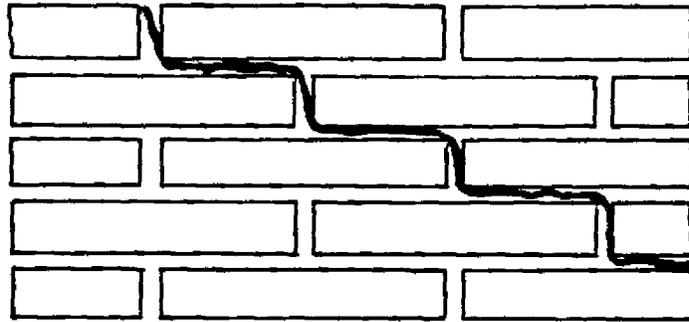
GRIETA TIPICA DE ALBAÑILERIA
